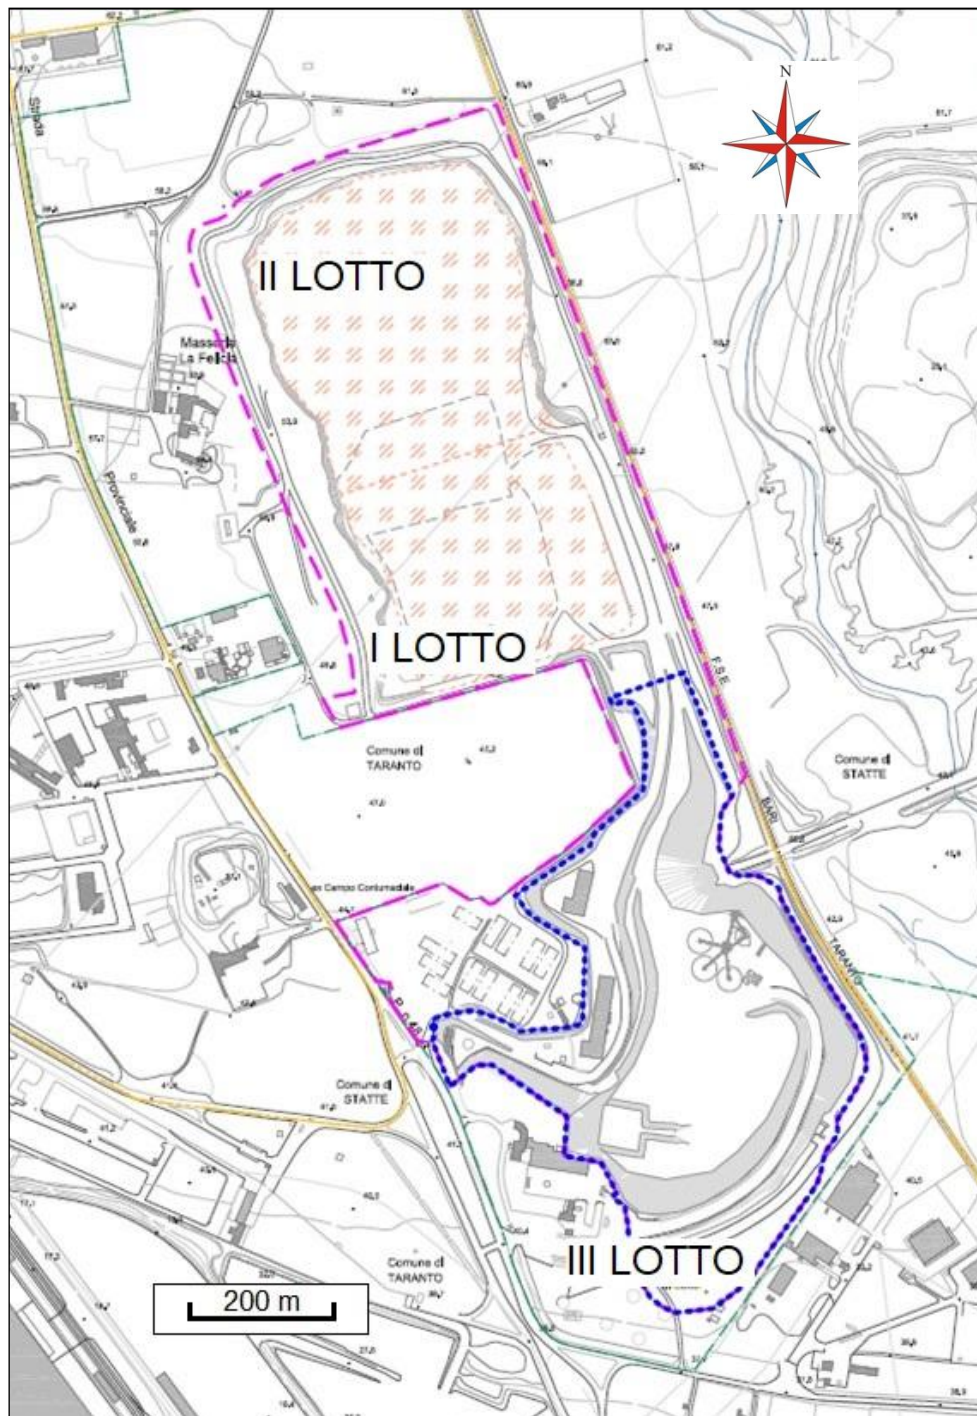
Planimetria della discarica (I, II e III lotto)
